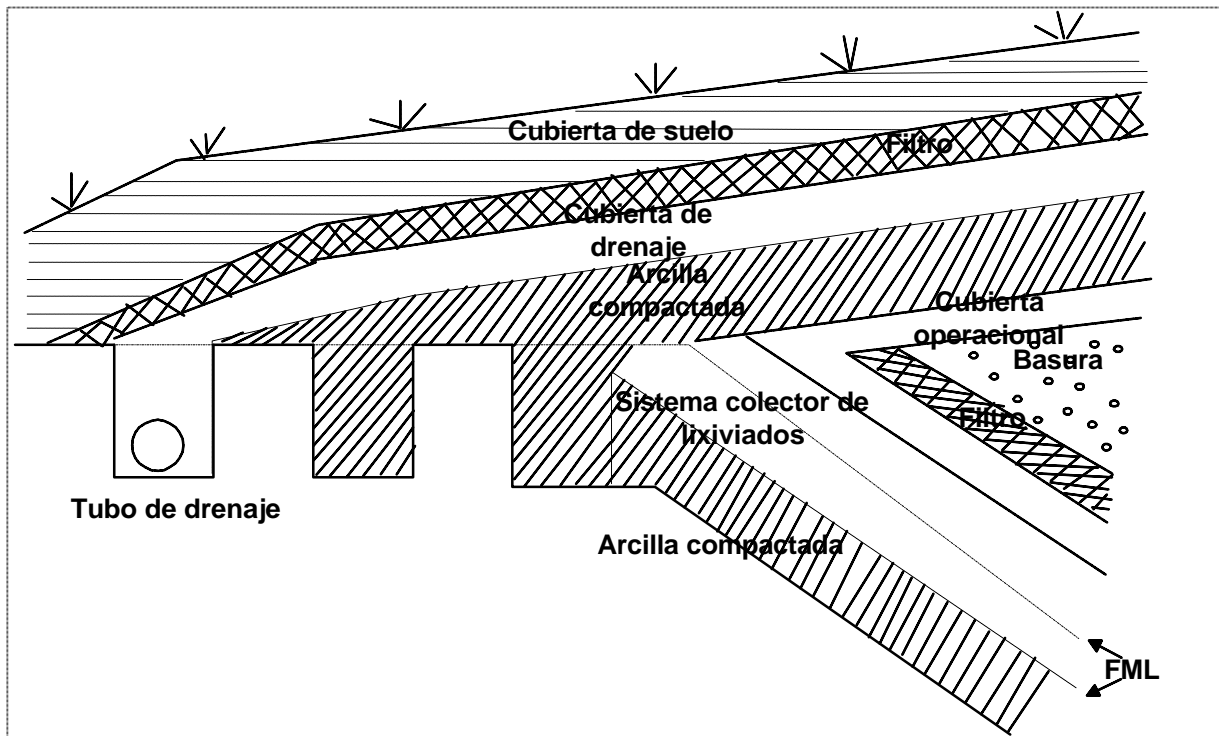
Sistema de impermeabilización y drenaje para lixiviados. (Tomado de Mc Bean, Rovers & Farquhar. *Solid waste landfill. Engineering and design*, 1995).
